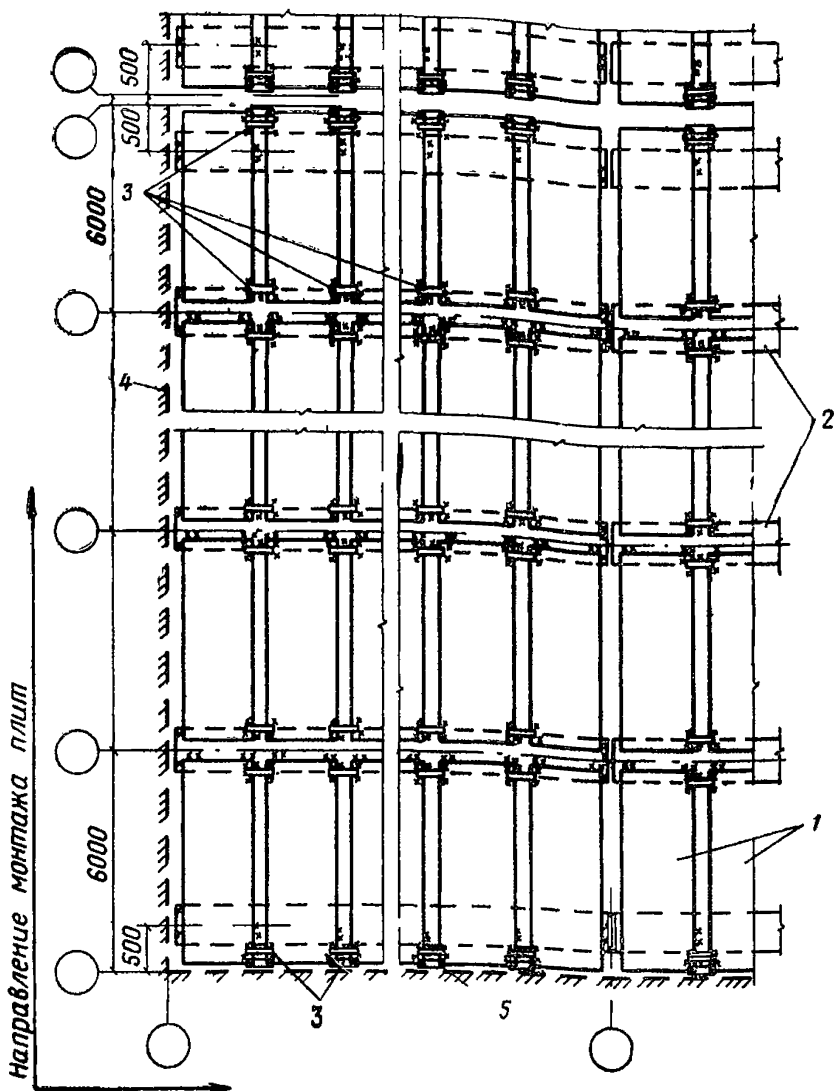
Приварка плит к стропильным конструкциям покрытия и соединение плит между собой стальными накладками в зданиях с расчетной сейсмичностью 9 баллов
